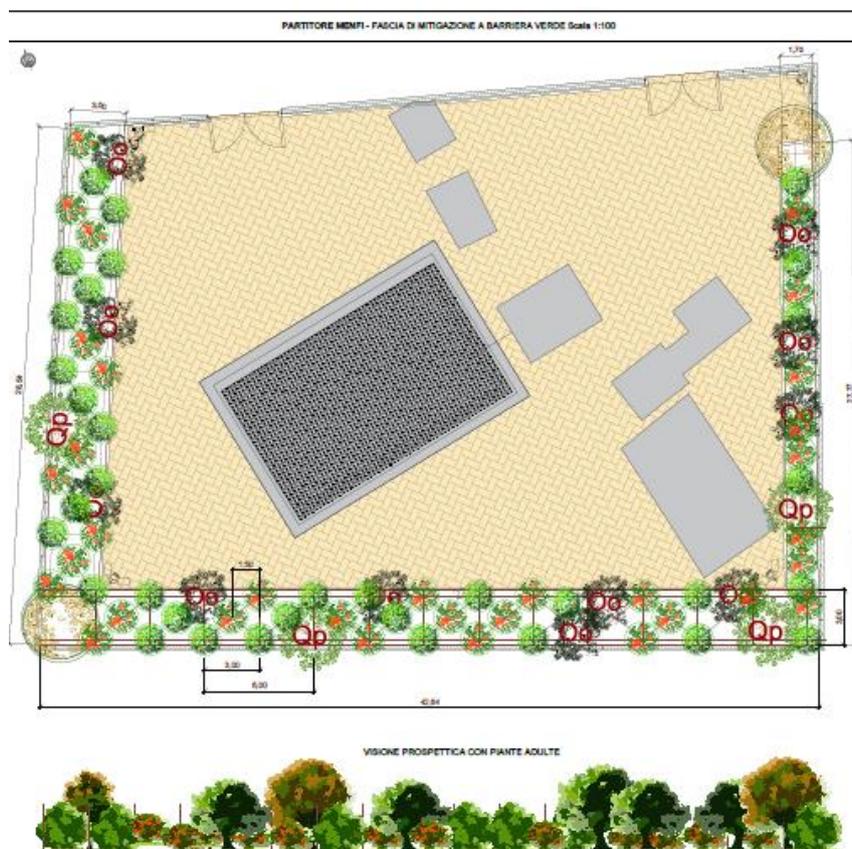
planimetria di progetto della barriera verde per il partitore Menfi
